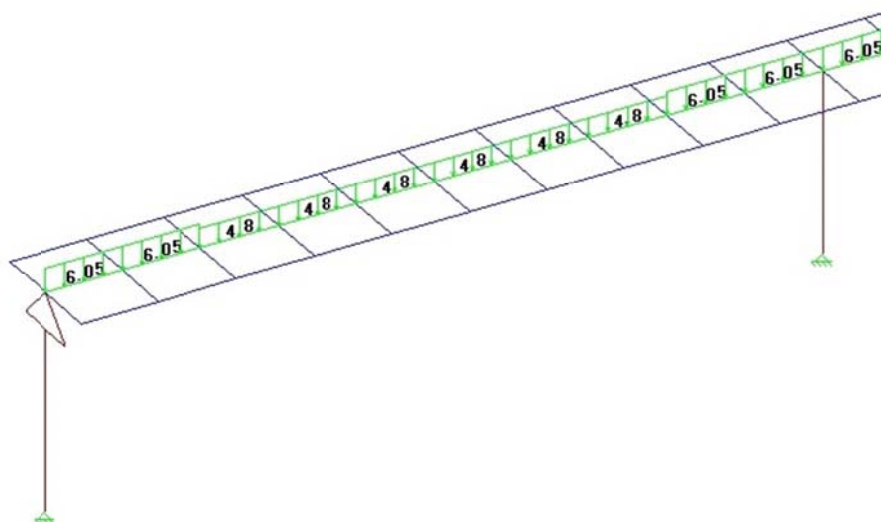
Carga g2 – lajes sobre seção caixaõ [tf/m] – STRAP 2013
